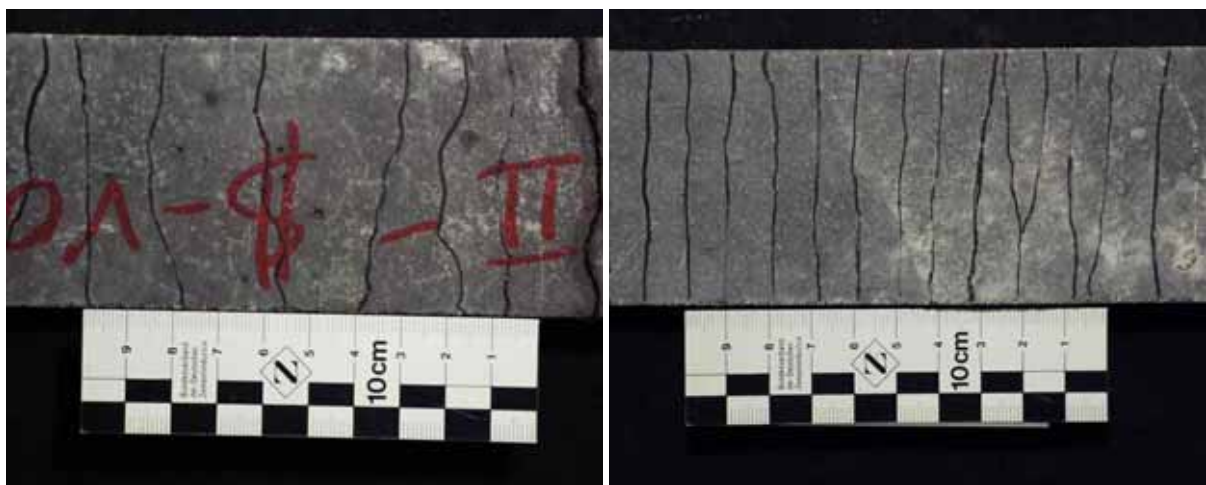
Rissbilder von einem nicht vorgespannten Betonprobekörper (links) und einem mit  $3,0 \text{ N/mm}^2$  vorgespannten Betonprobekörper (rechts) mit einer textilen Bewehrung aus besandetem Carbongelege (C-EPS).
